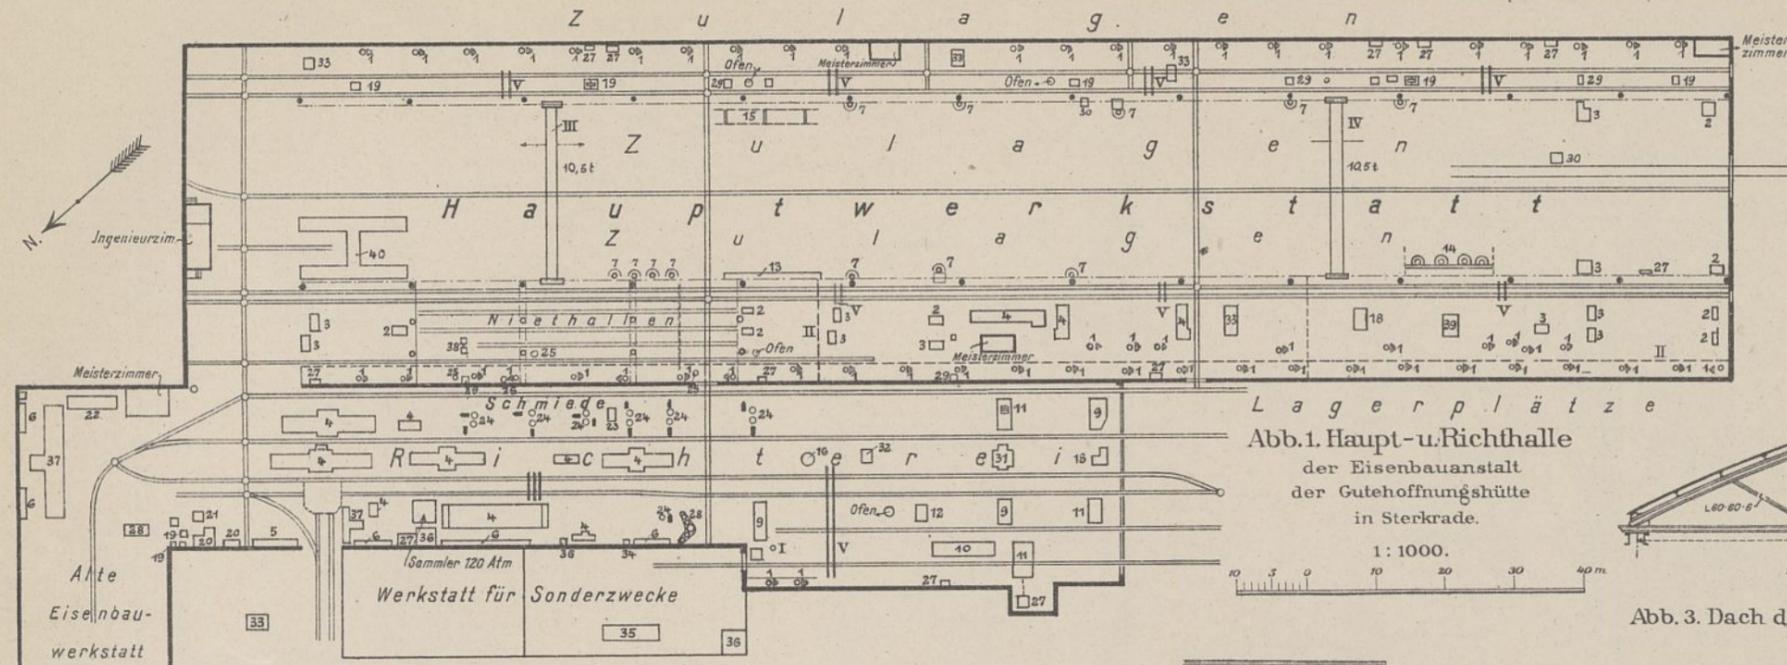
Haupt- u. Richthalle der Eisenbauanstalt der Gutehoffnungshütte in Sterkrade. 1: 1000.
